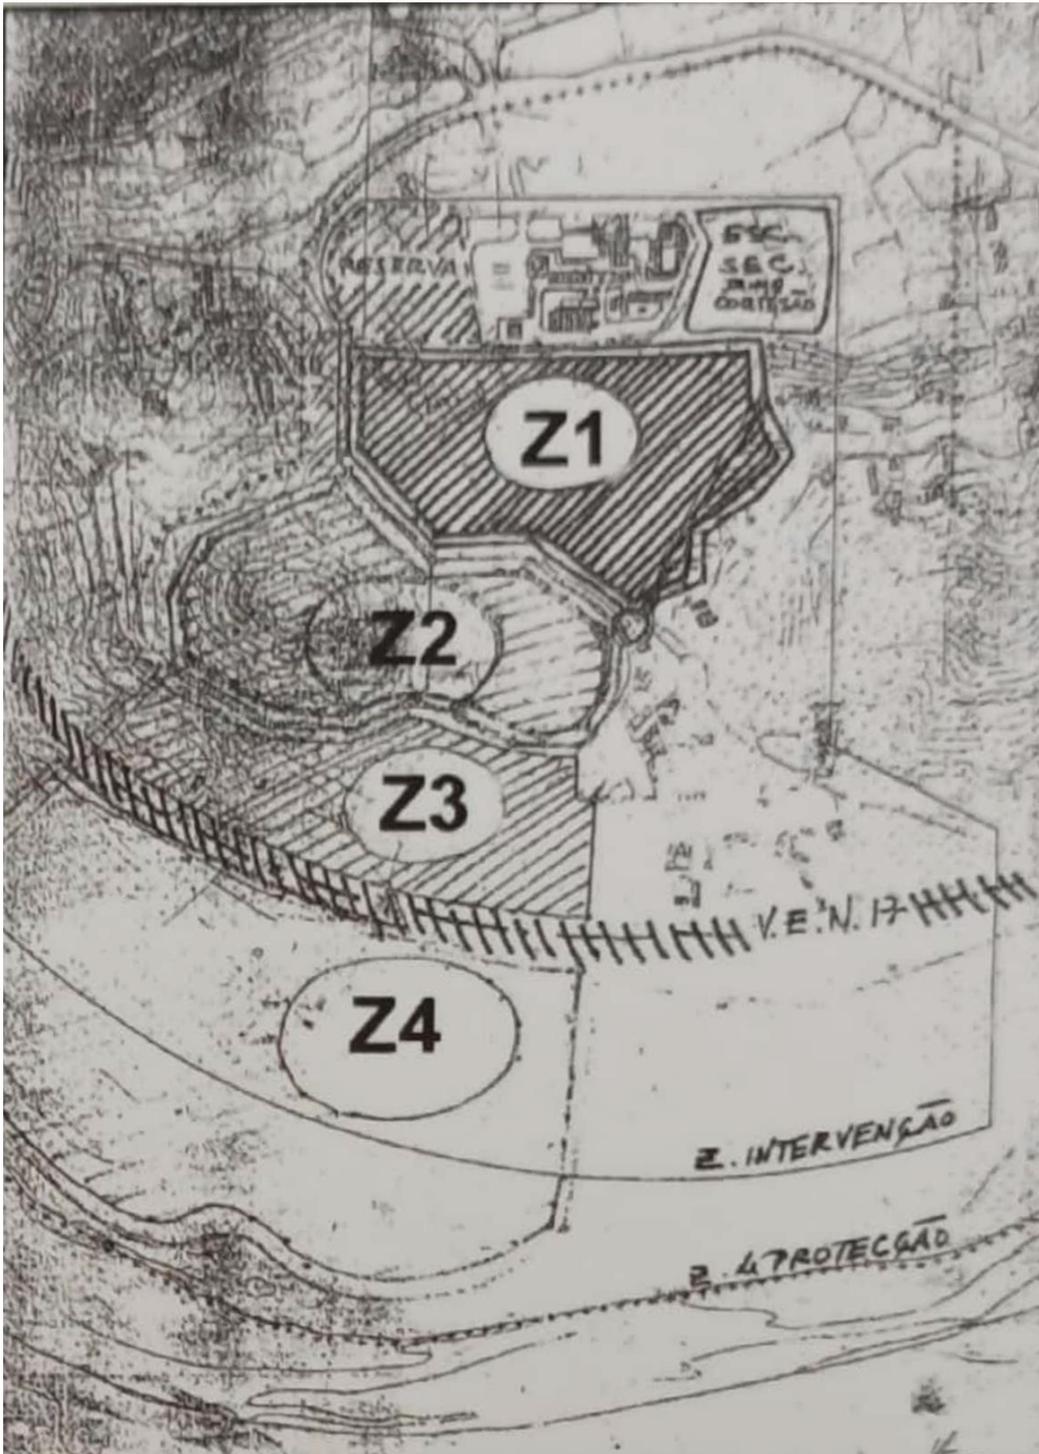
Planta de zonamento do Polo II, 1984, pelo Arquiteto João Pedro Magalhães Silva.
